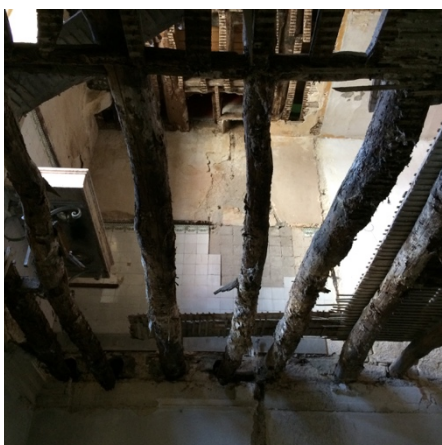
Estado do pavimento da divisão Norte, do lado nascente, piso 2.
